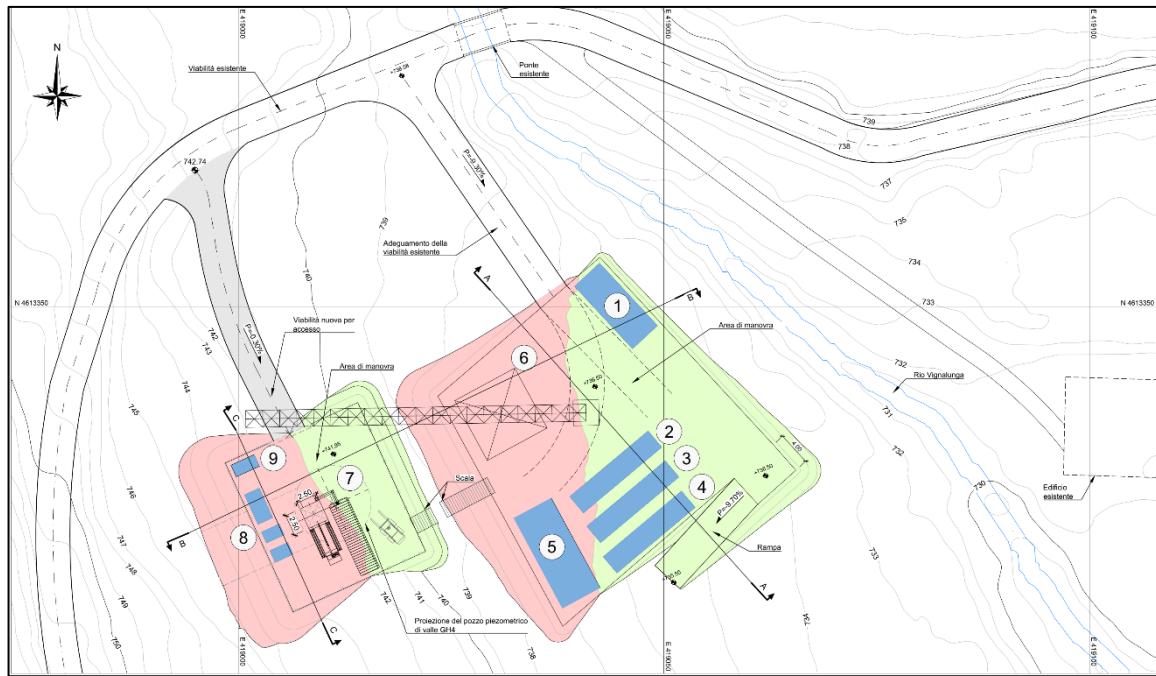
Ambito Pizzone - Area di cantiere CA.GH4 – Pozzo piezometrico di valle
